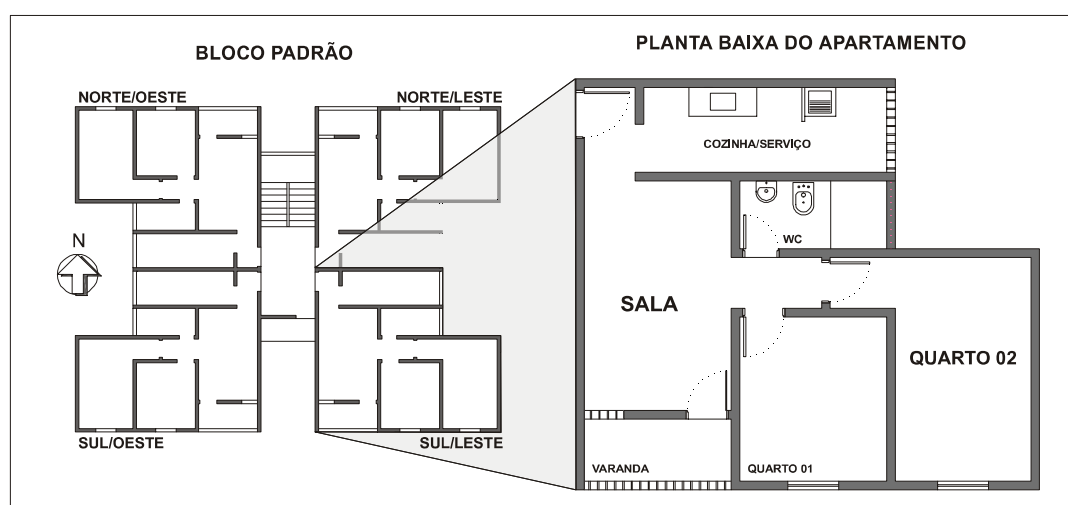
Planta baixa dos apartamentos do conjunto Mangabeira VII.
